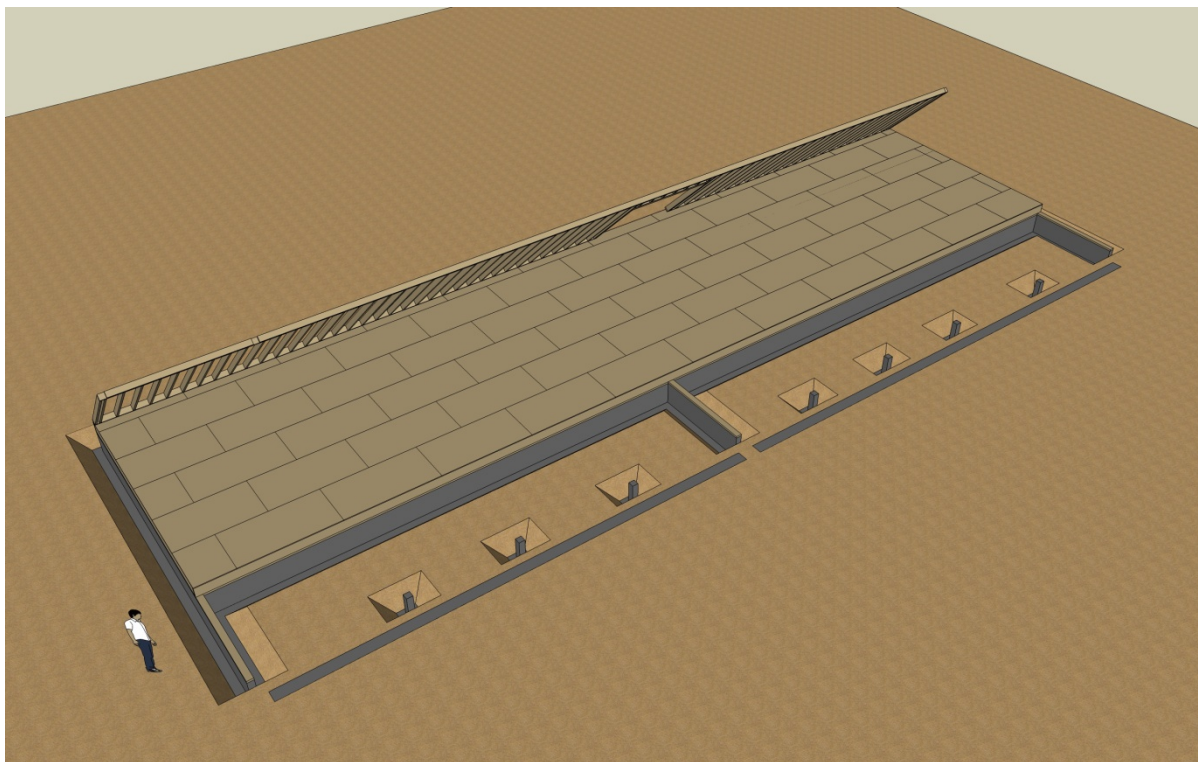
Levantamento manual da parede exterior. Uma parede com este comprimento seria feita e levantada em troços. A colocação da segunda travessa superior com a parede já na vertical une os vários troços.
